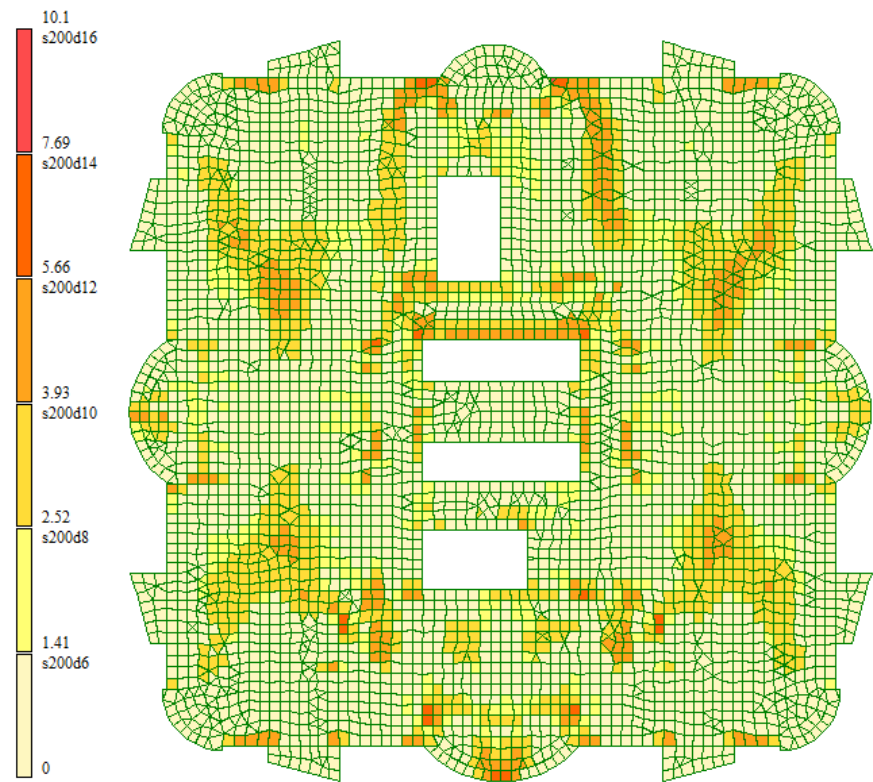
Схема армирования верха плиты перекрытия по оси OX и по оси OY
